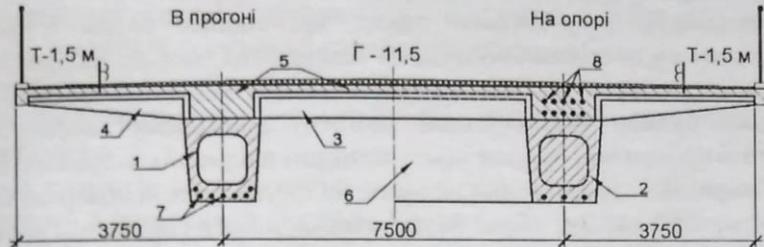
Двобалкова нерозрізна збірно-монолітна залізобетонна прогонова будова моста для складних умов будівництва: 1 - збірна прогонова балка; 2 - монолітна або збірна надопорна балка; 3 - збірна ребриста пilitа; 4 - збірна ребриста консольна пilitа; 5 - бетон замонолічування головних балок і плити; 6 - монолітна діафрагма в стиках і над опорами; 7 - напружену арматуру збірних балок; 8 - напружену арматуру в надопорних зонах і стиках
